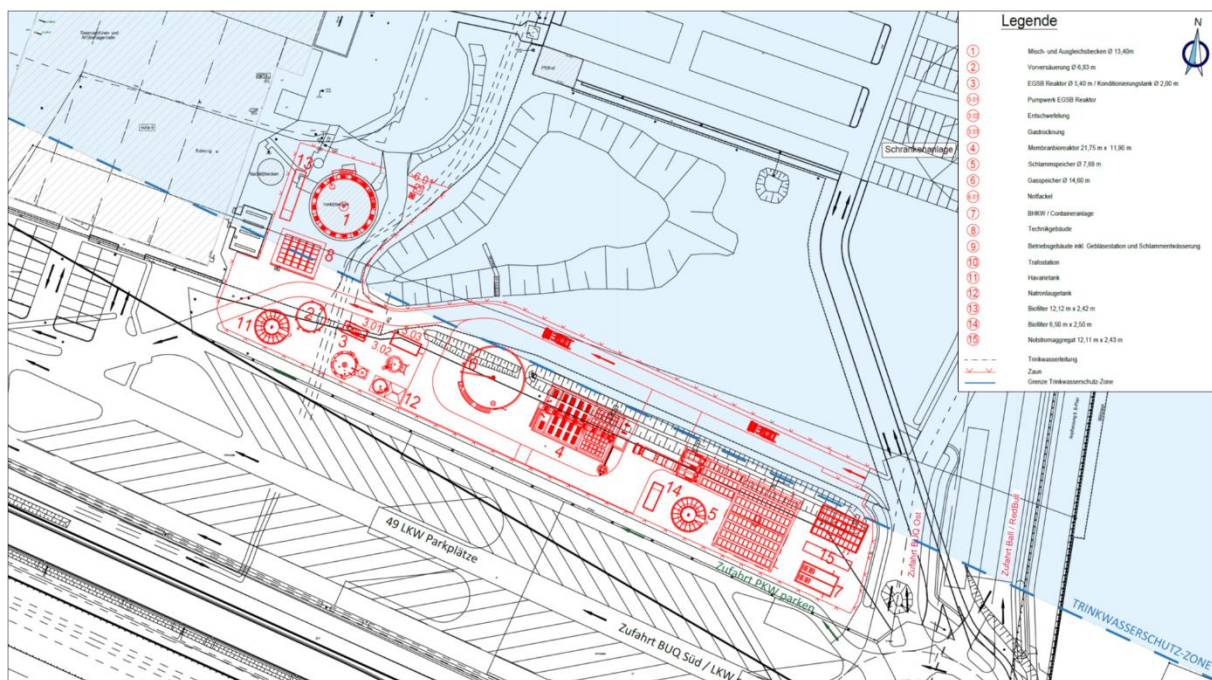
Lageplan der geplanten Anlagen der BHKW-Anlage/Kläranlage /26/
